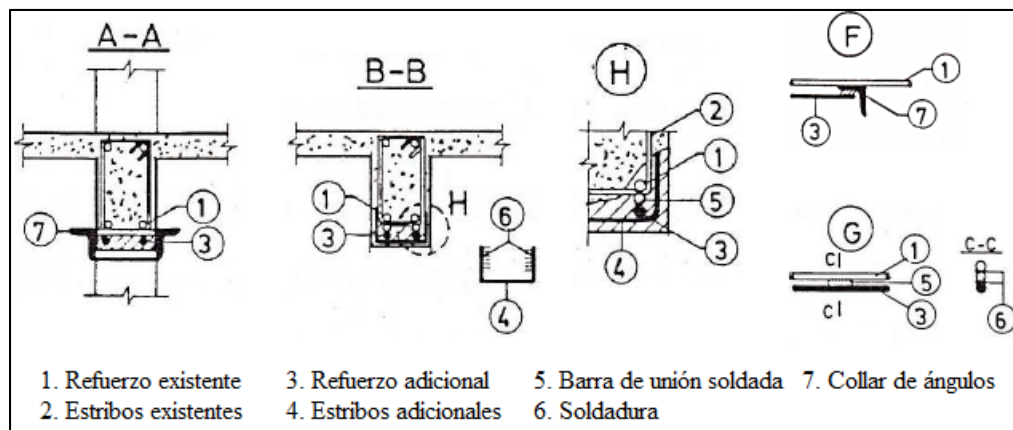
Encamisado con concreto reforzado por flexión. (Armendáriz, 2015)
